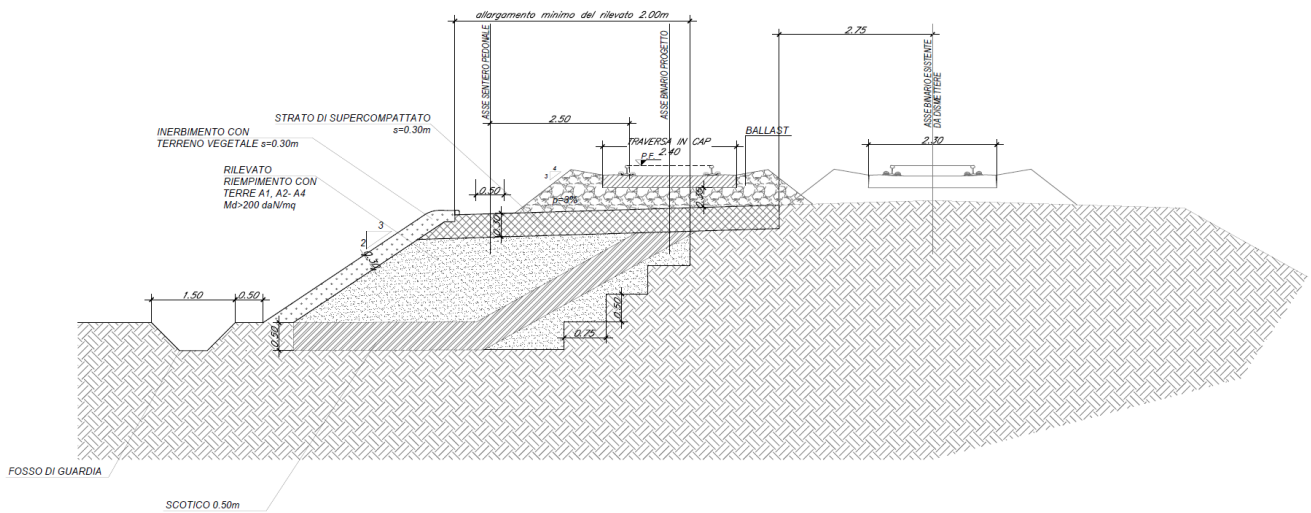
Sezione tipo in rilevato; Variante Provvisoria alla Linea Storica, tratto in ammorsamento al corpo stradale esistente
